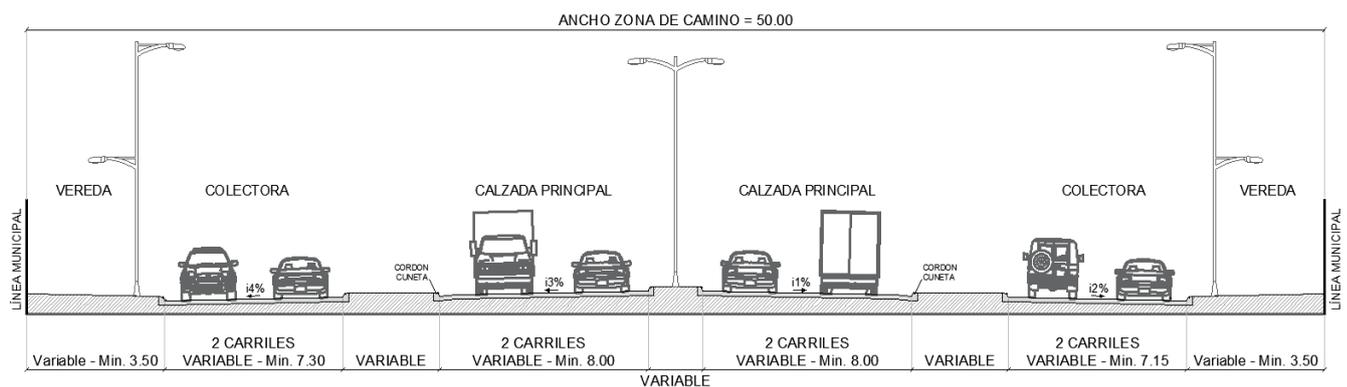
Perfil tipo de Obra Básica Zona R.N.Nº3
